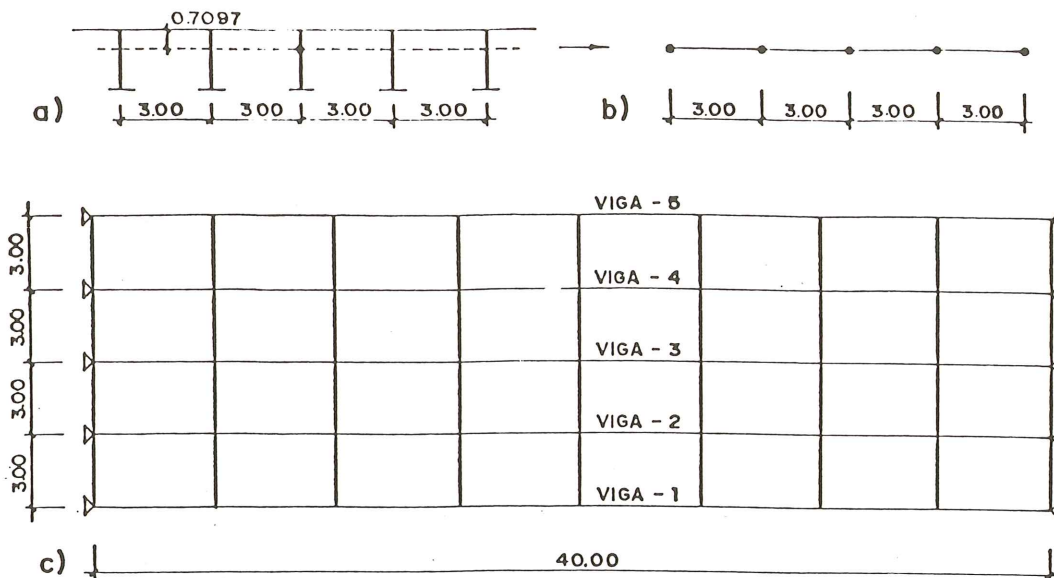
Paso de estructura real a emparrillado plano. a) Sección transversal real; b) Sección emparrillado; c) Planta emparrillado.
